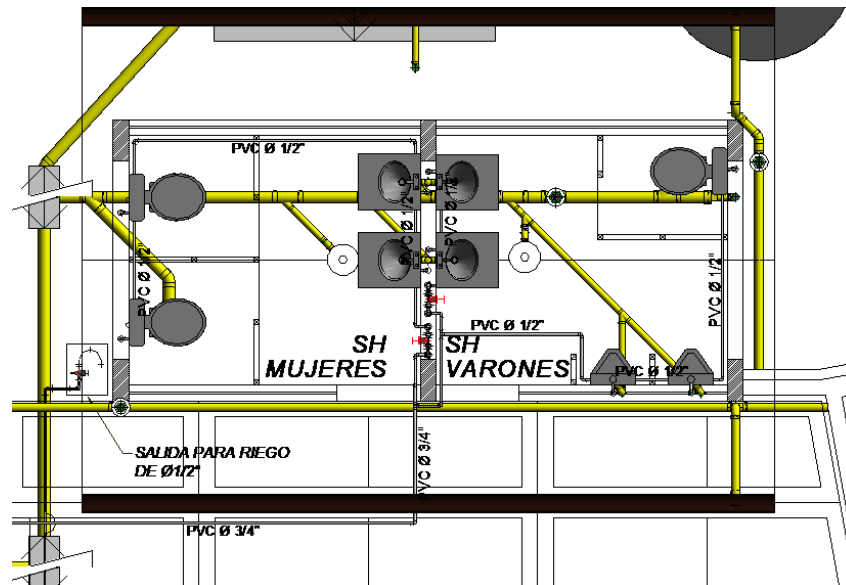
Plano planta SSHH - Sótano. Fuente: Autor
